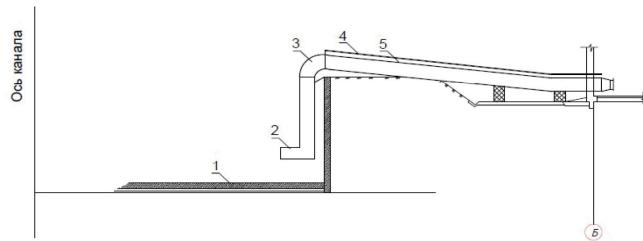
Всасывающий раструб всасывающего трубопровода до его реконструкции: 1 – дно канала; 2 – всасывающий головок; 3 – переход; 4 – вакуумный трубопровод, 5 – всасывающий трубопровод
